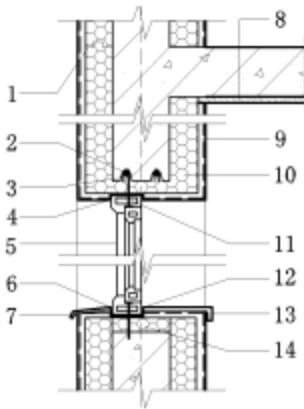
单层门窗框与保温墙体连接组合构造示意
